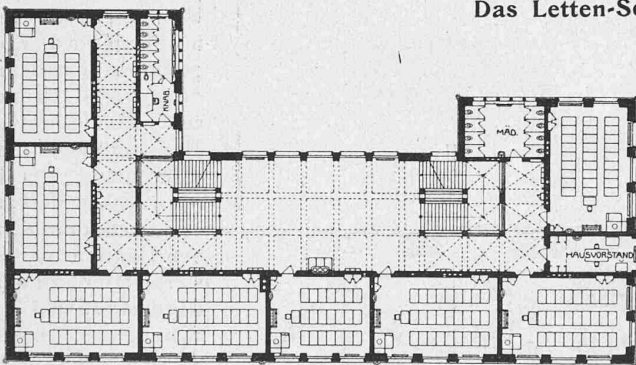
Grundriss vom II. Stock. — 1:600.
